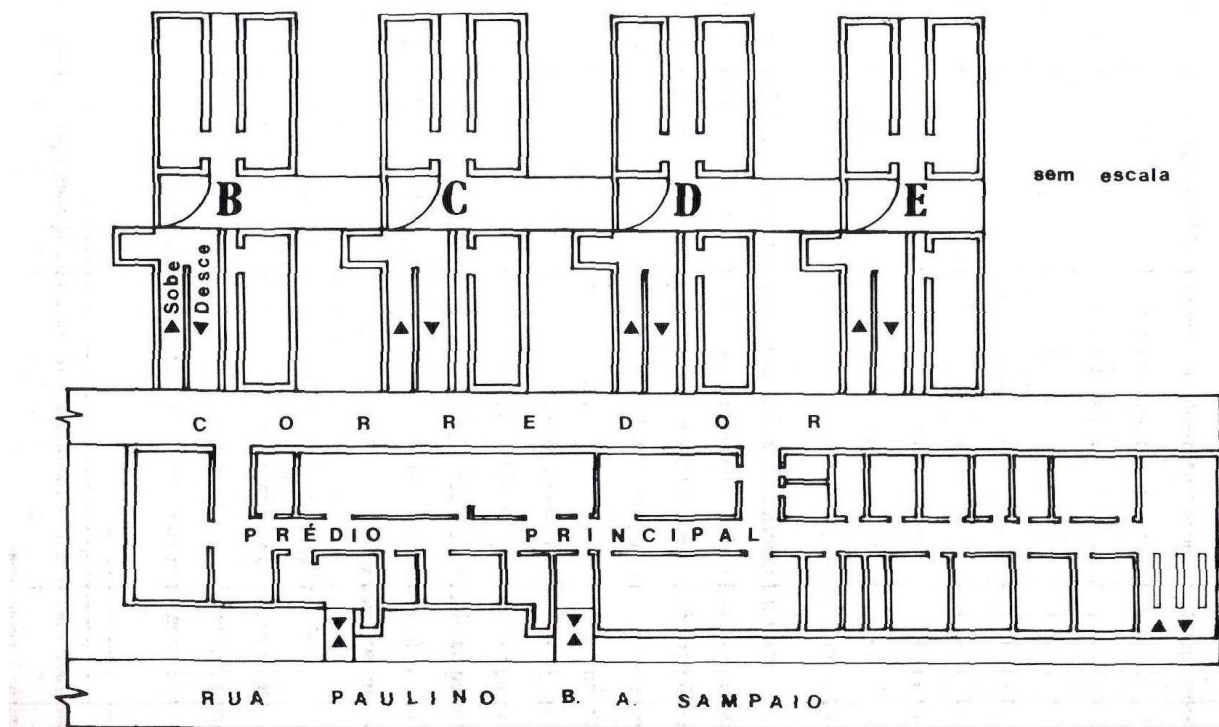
Planta baixa do prédio principal e blocos B,C,D e E (sem escala)
